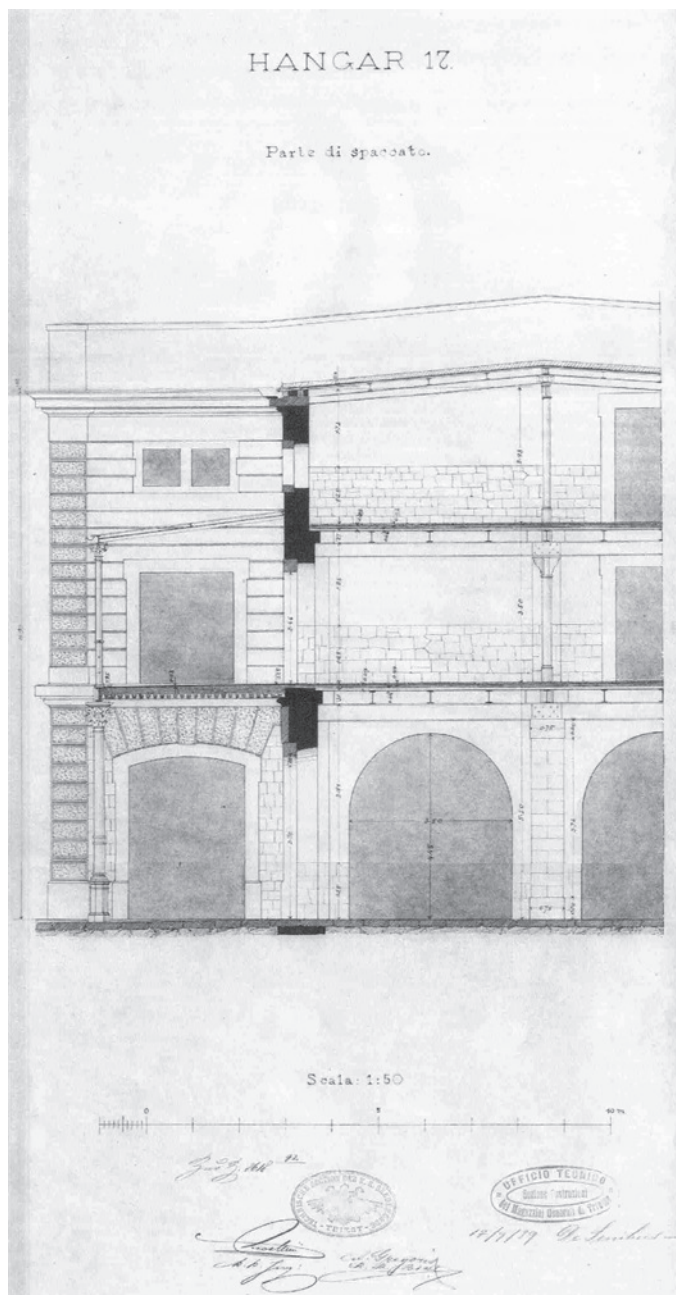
Spaccato dell’Hangar n. 17, diretta applicazione della soletta Monier su più appoggi proposta da Koenen nel 1886, fonte Archivio Storico dell’Autorità Portuale.
